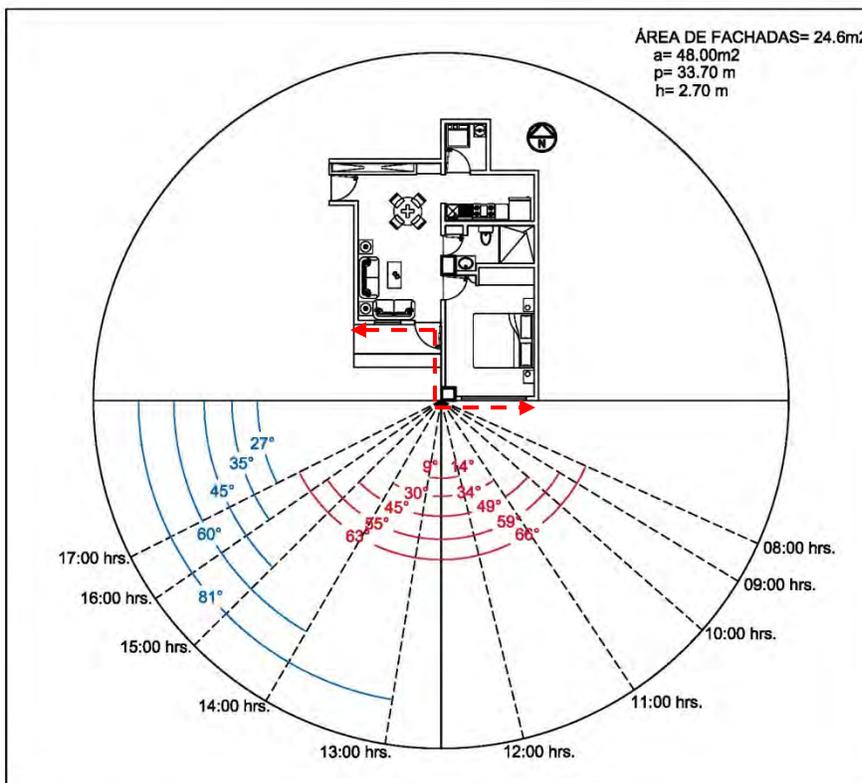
Ángulos de incidencia solar sobre la fachada del departamento tipo planta para el mes de Enero.
